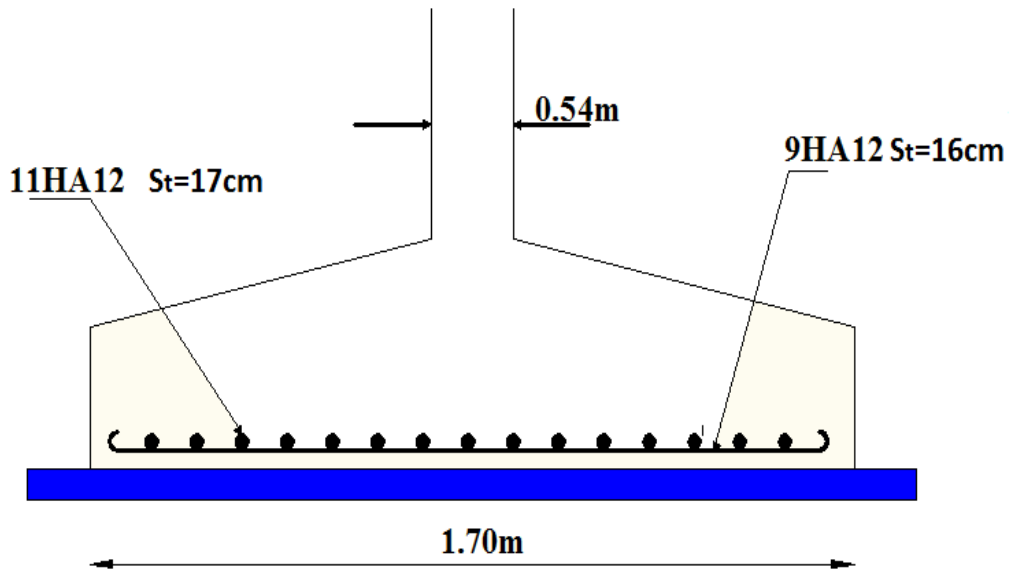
Schéma de ferrailage de la semelle type 1 (semelle de poteau).
